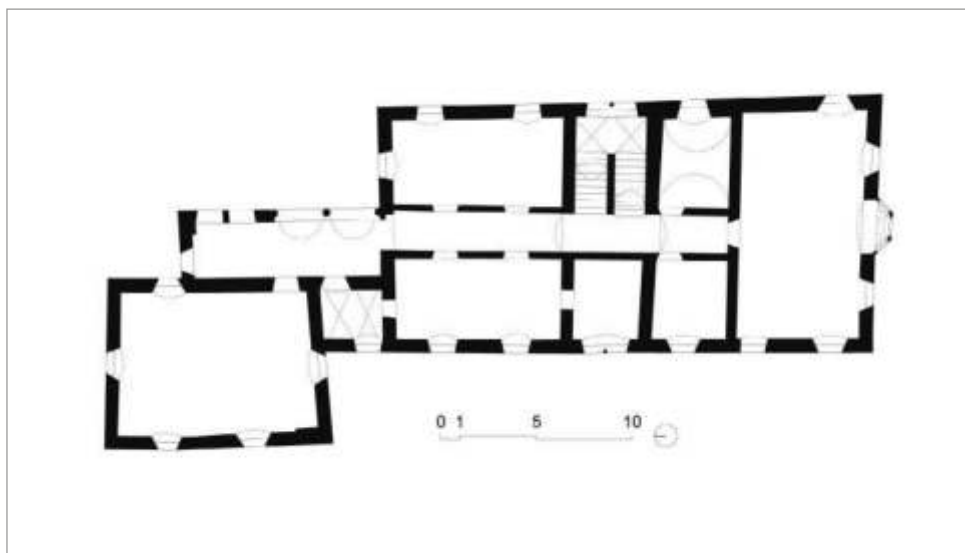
Hypothetischer Grundriss Schrofenstein, erstes Obergeschoss um 1380. Gezeichnet von Achim Reese
